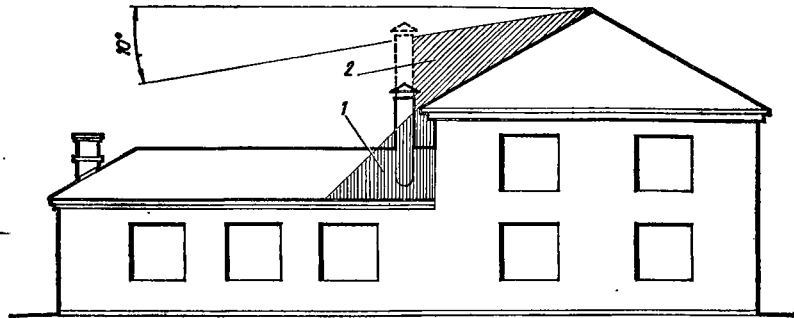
Вывод дымовой трубы из зоны ветрового подпора, расположенной впритык к более высокой стене смежного здания:
